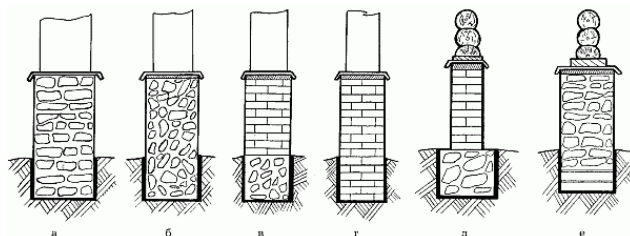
Фундаменты из различных строительных материалов: а – бутовый; б – бутобетонный; в – кирпичный с бутобетоном; г – кирпичный; д – кирпичный с бутом; е – бутовый на песчаной подушке
